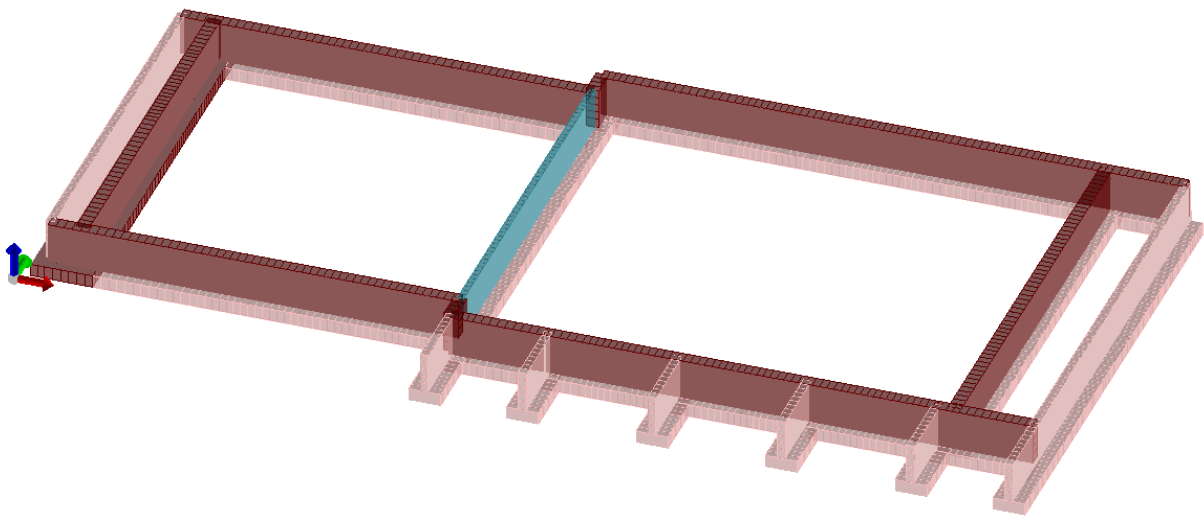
Modello Strutturale Vista solida fondazioni - vista assonometrica 1.
